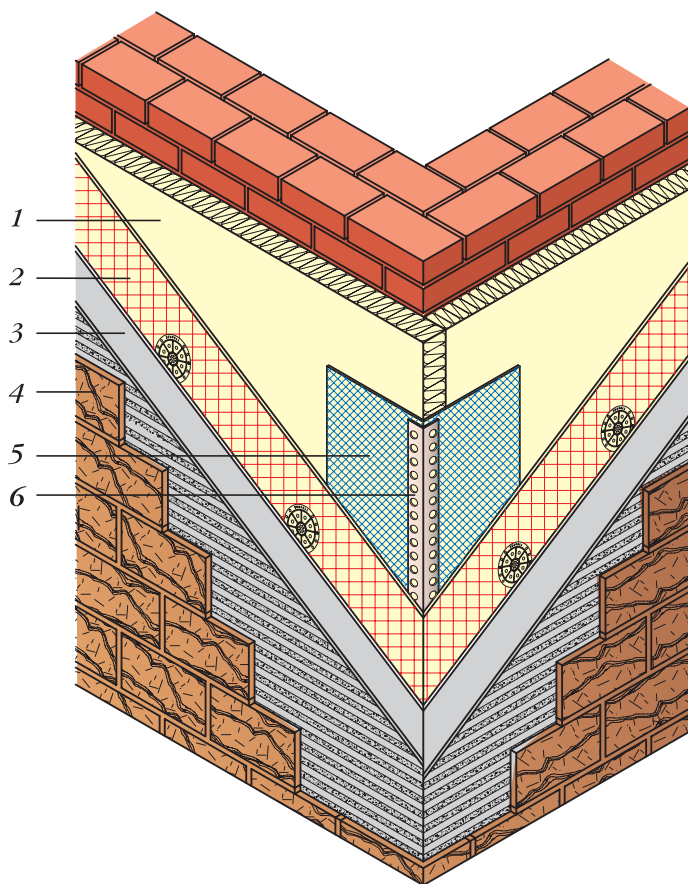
Армирование угла стены: 1 — утеплитель; 2 — сплошное армирование стены сеткой (устанавливается только под облицовку плиткой); 3 — слой армирующего раствора; 4 — клинжерная плитка; 5, 6 — уголок с армирующей сеткой
